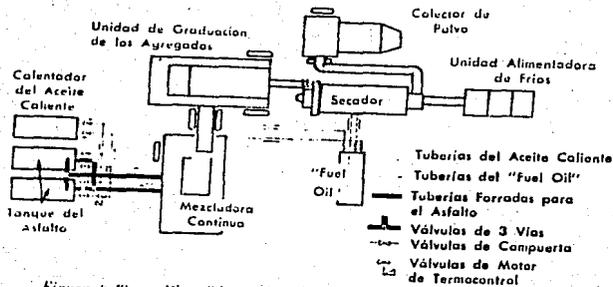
Plan Típico de una Planta Continua Barber-Greene y Distribución de las Tuberías.
